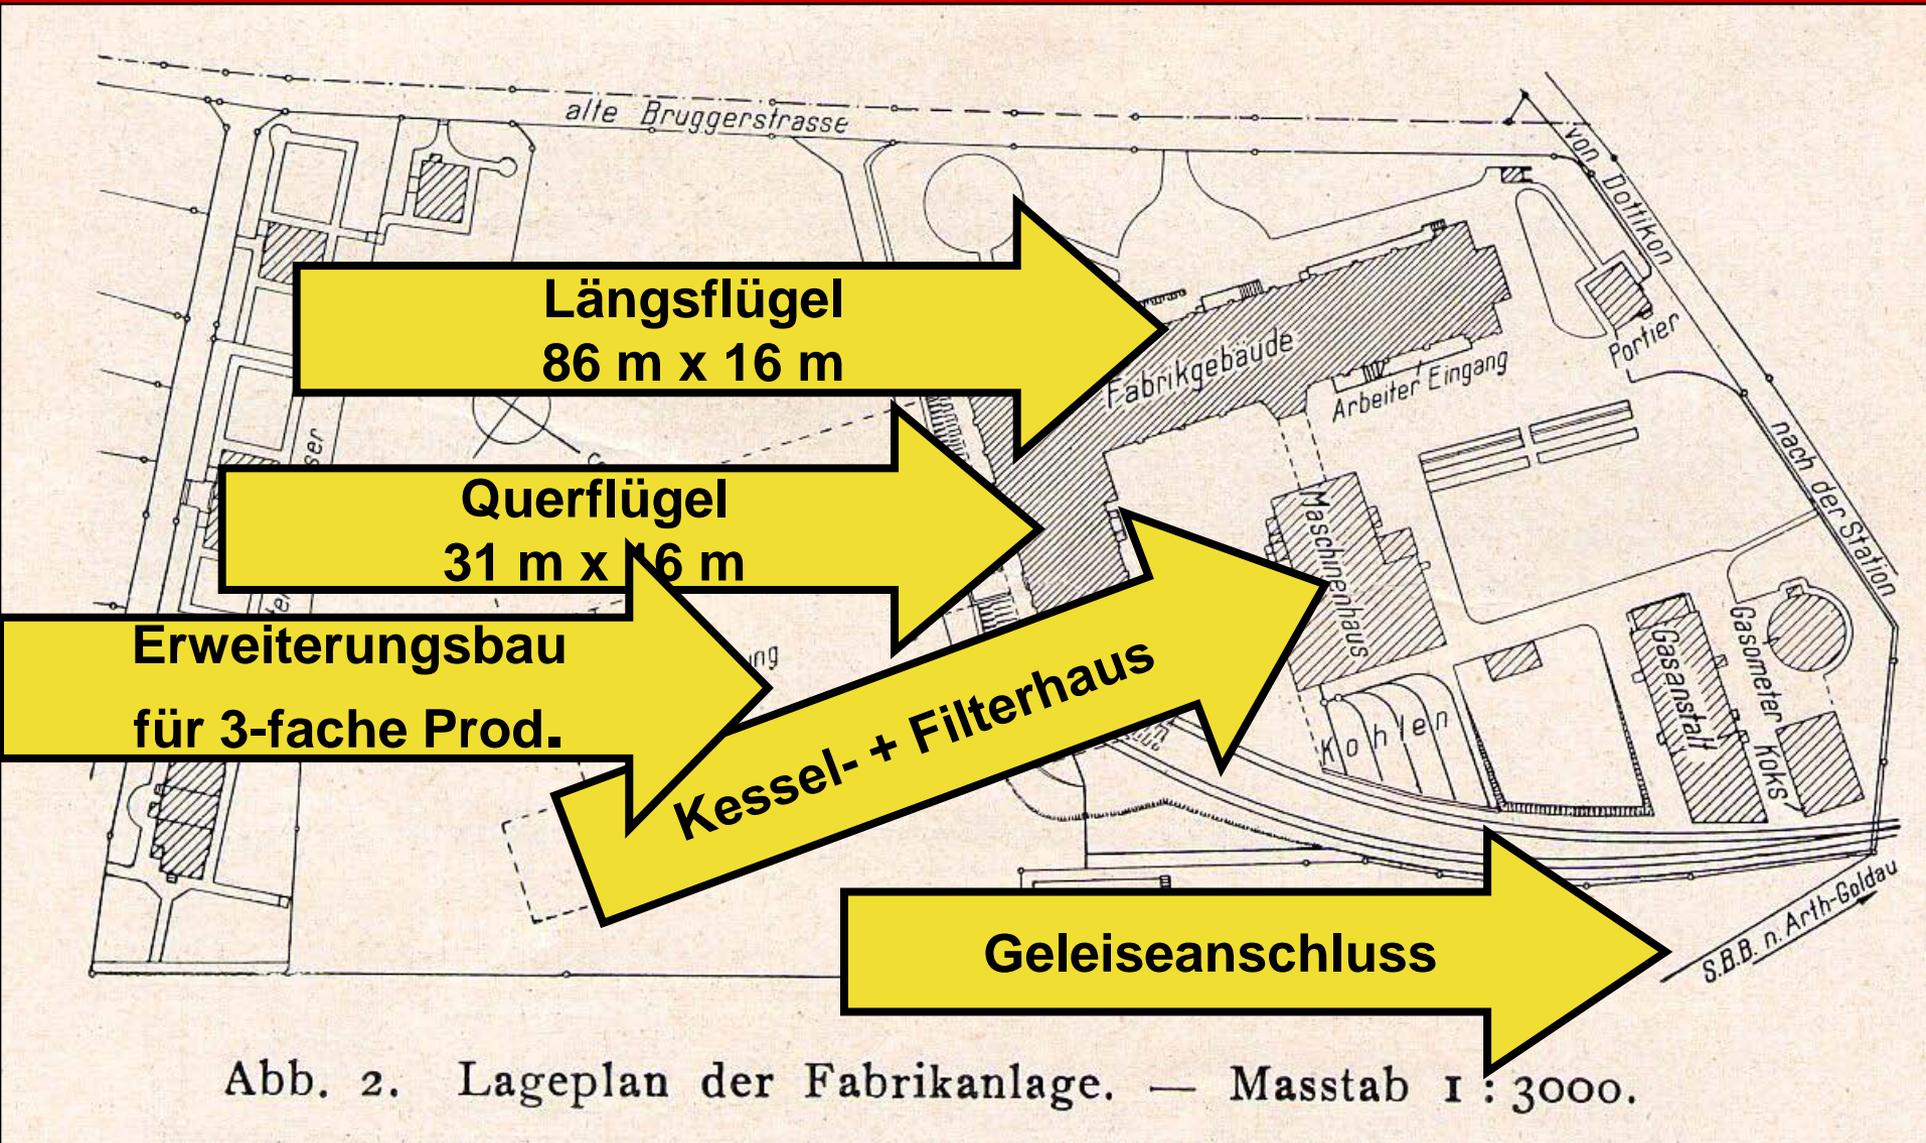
Lageplan der Fabrikanlage. — Masstab 1 : 3000.
